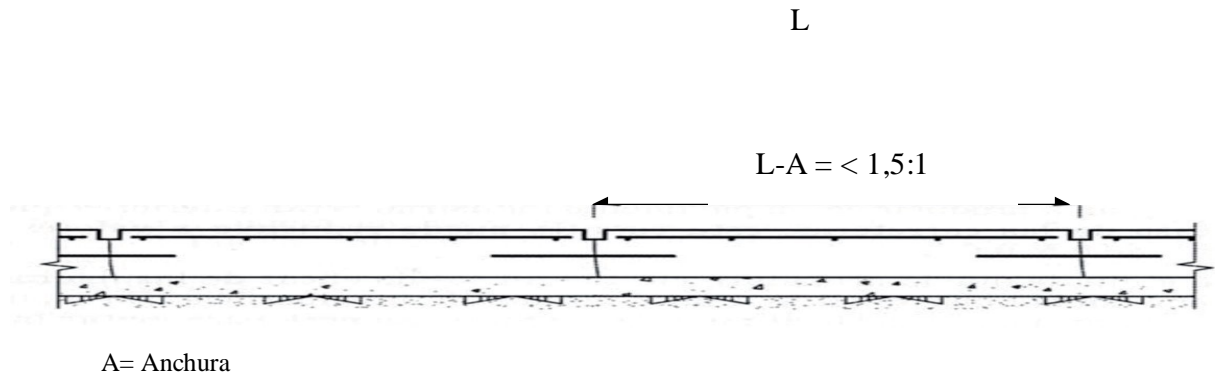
Detalle de la armadura con mallazo y la correcta ejecución de la junta de contracción (L y e)
